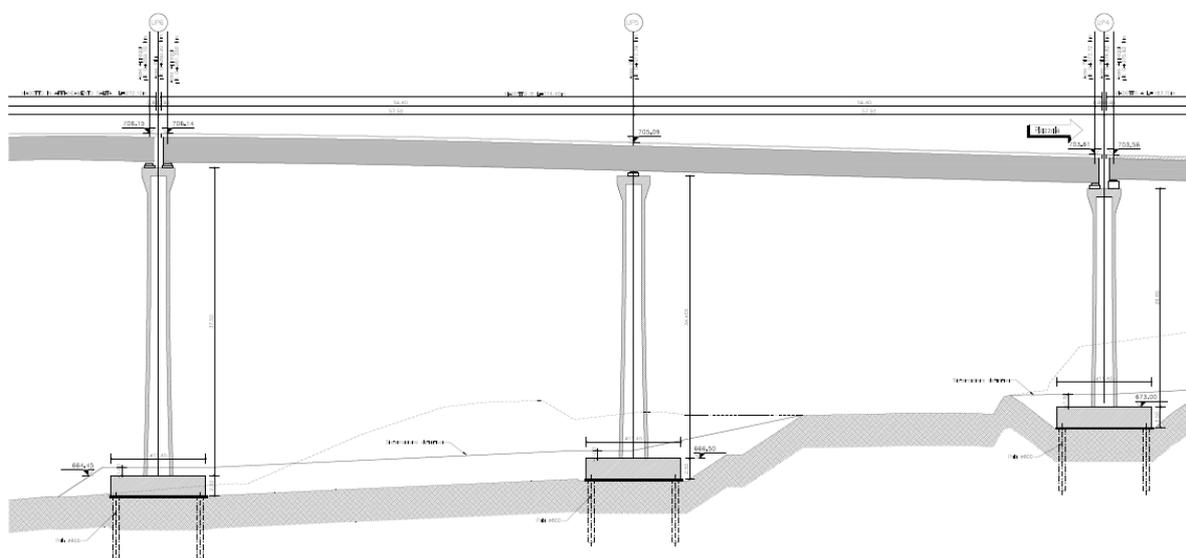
Individuazione planimetrica Viadotto B - rampa di uscita.
